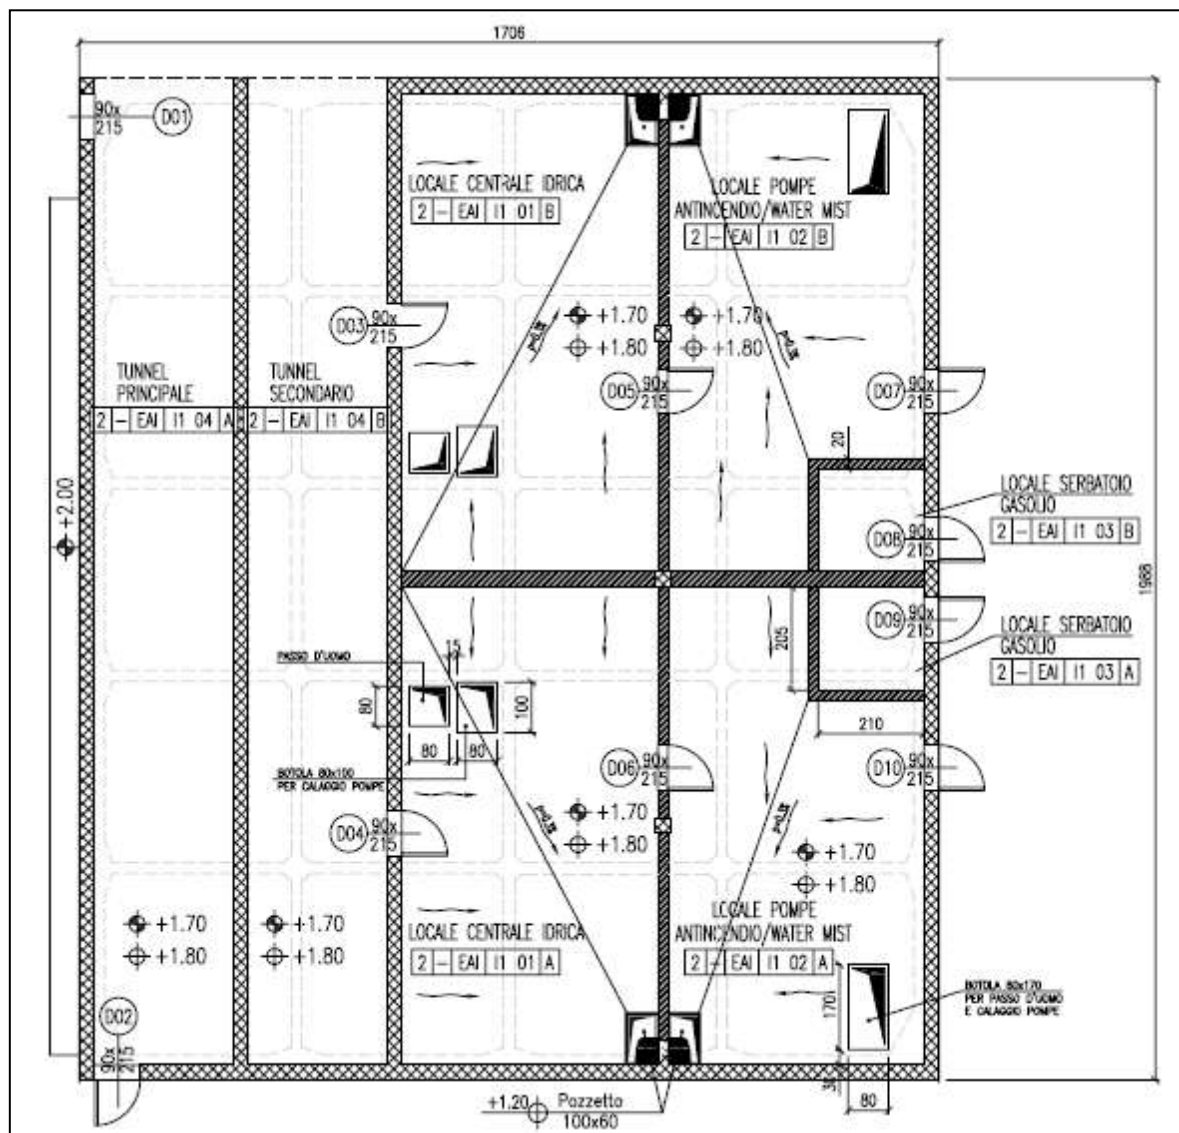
EDIFICIO ANTINCENDIO – STOCCAGGIO ACQUA - PLANIMETRIA
